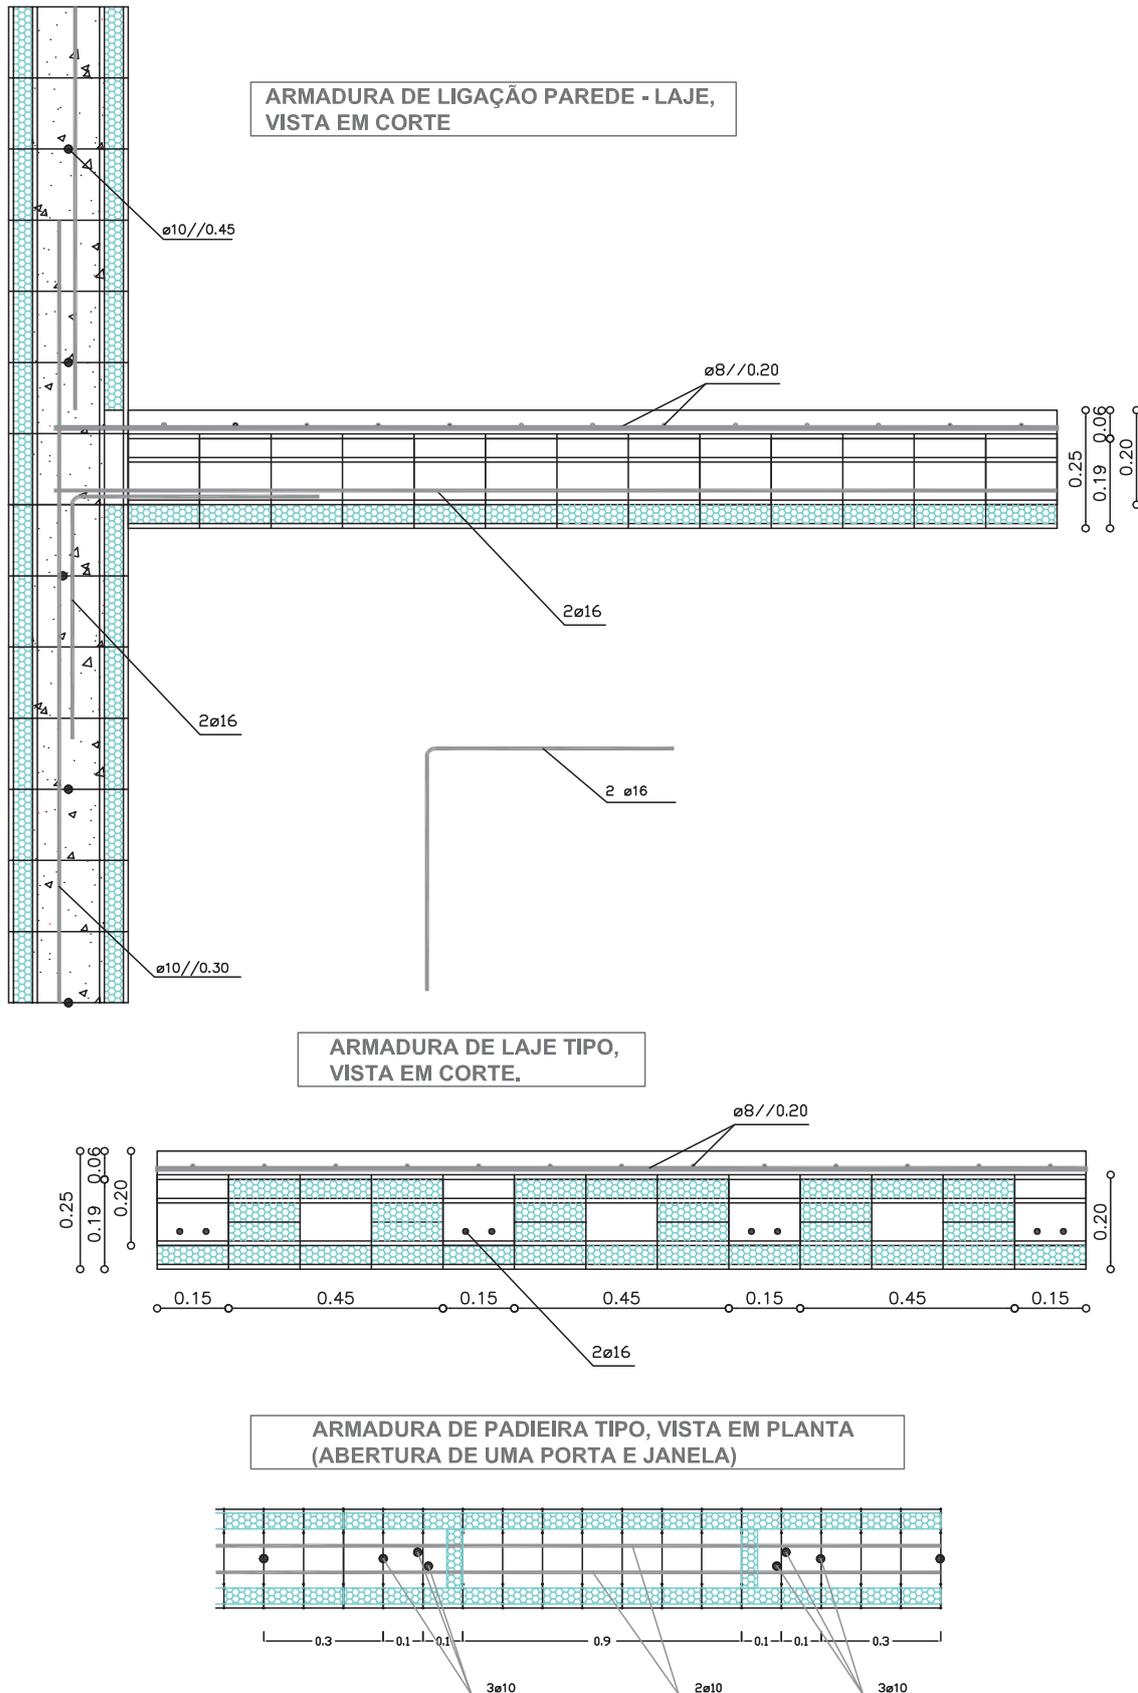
Pormenores estruturais SISMO® (Fonte, Technology, 2013)
